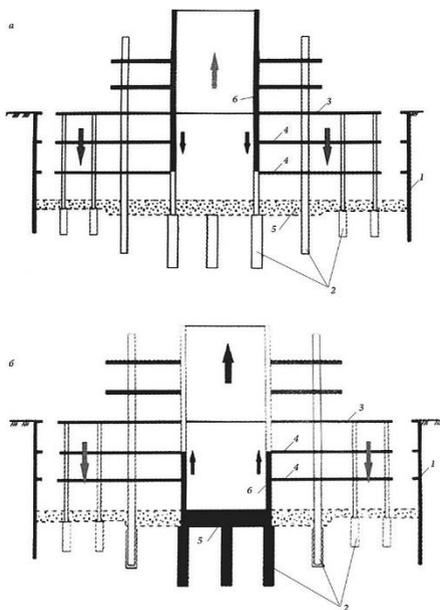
Технологическая схема возведения здания декарным методом: а — закрытым способом; б — полузакрытым способом: 1 — ограждение «стена в грунте»; 2 — сваи-колонны; 3 — перекрытие над первым заглубленным этажом; 4 — междуэтажные перекрытия; 5 — фундаментная плита; 6 — ядро жесткости
